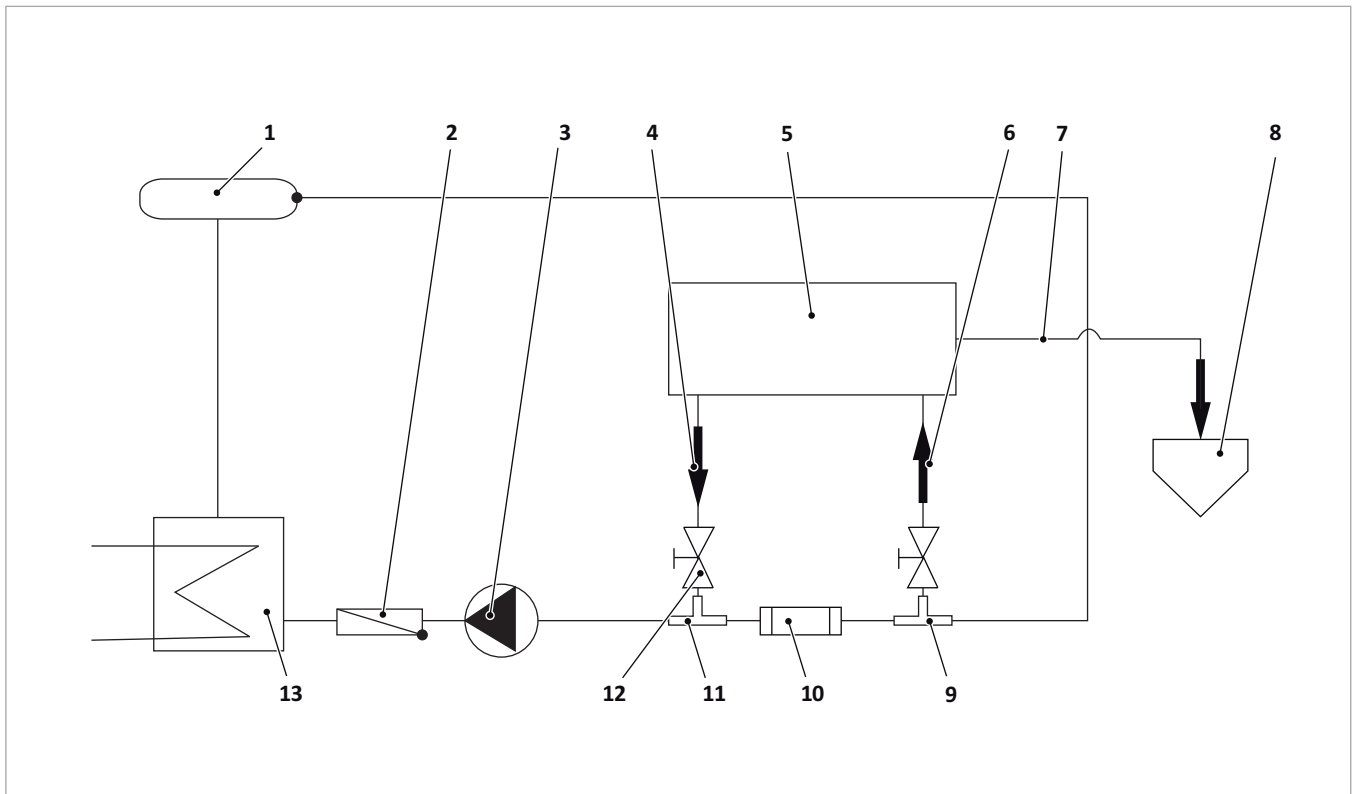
Einbauschema der Anlage in die Trinkwasserinstallation
